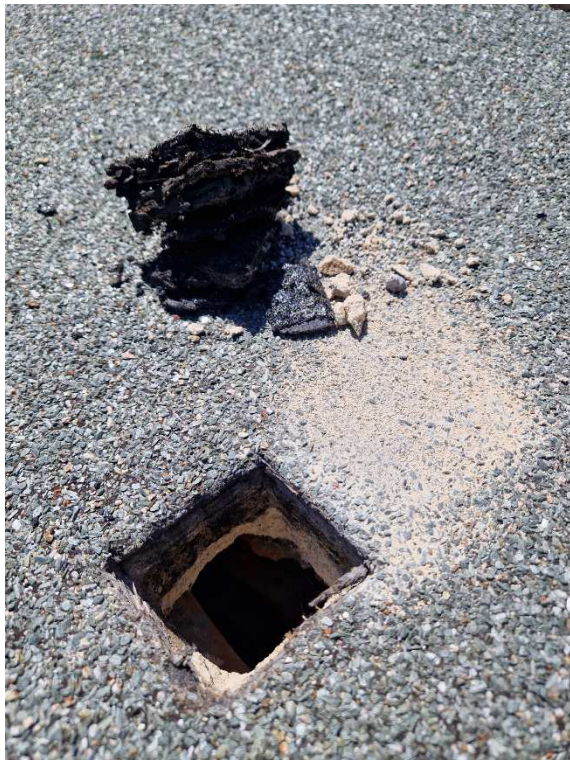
8: sonda ST 2.1 (STŘECHA)
